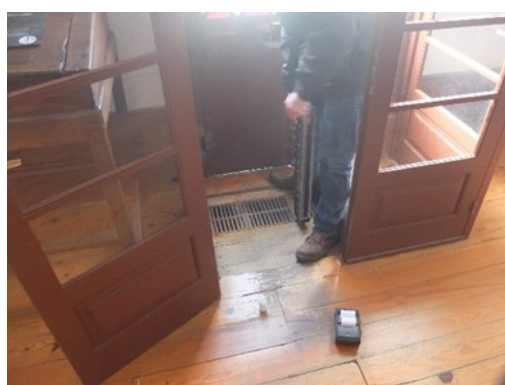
Detalhes do pavimento em madeira do piso 0
